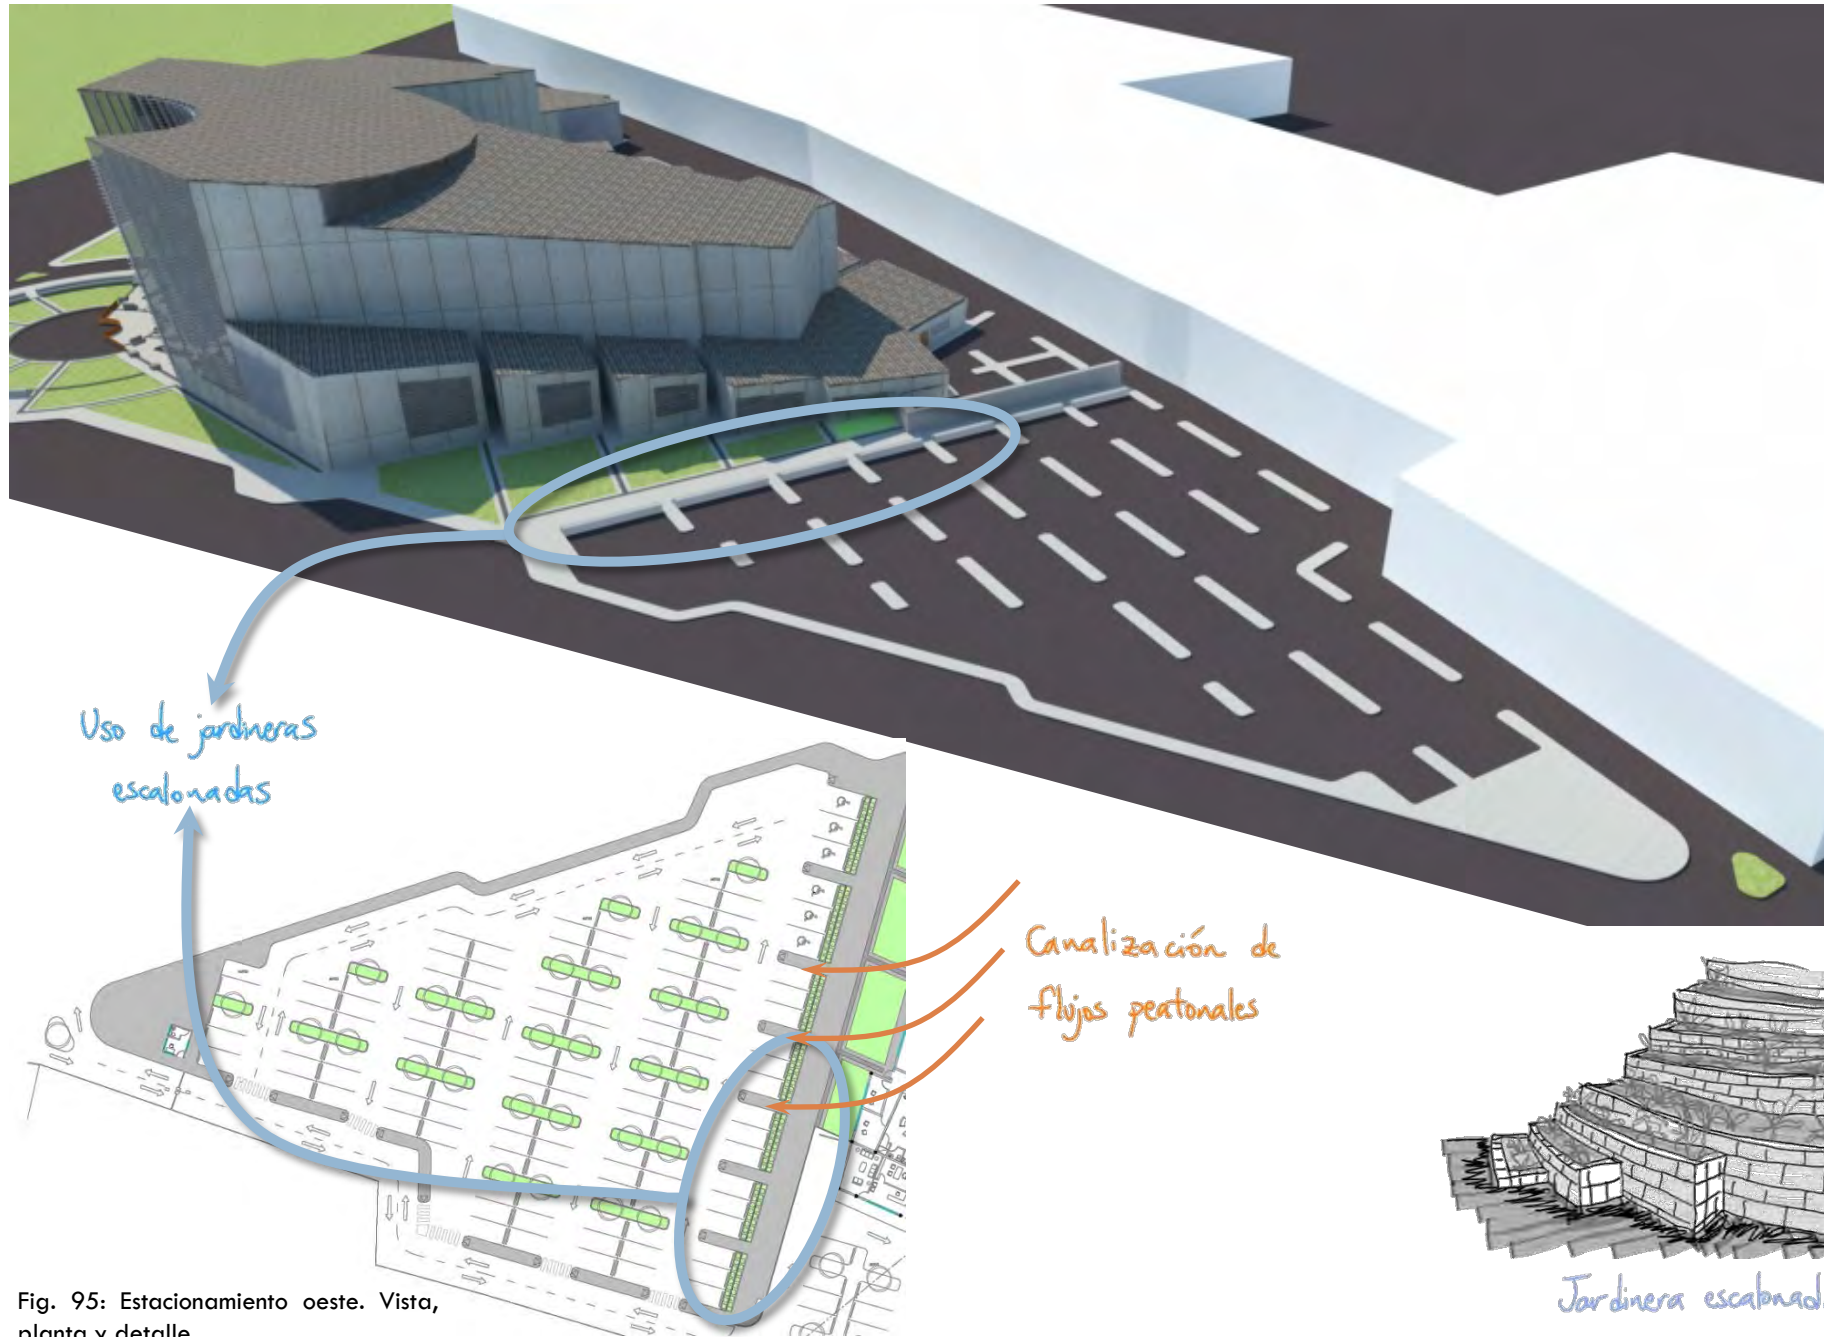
Estacionamiento oeste. Vista, planta y detalle
